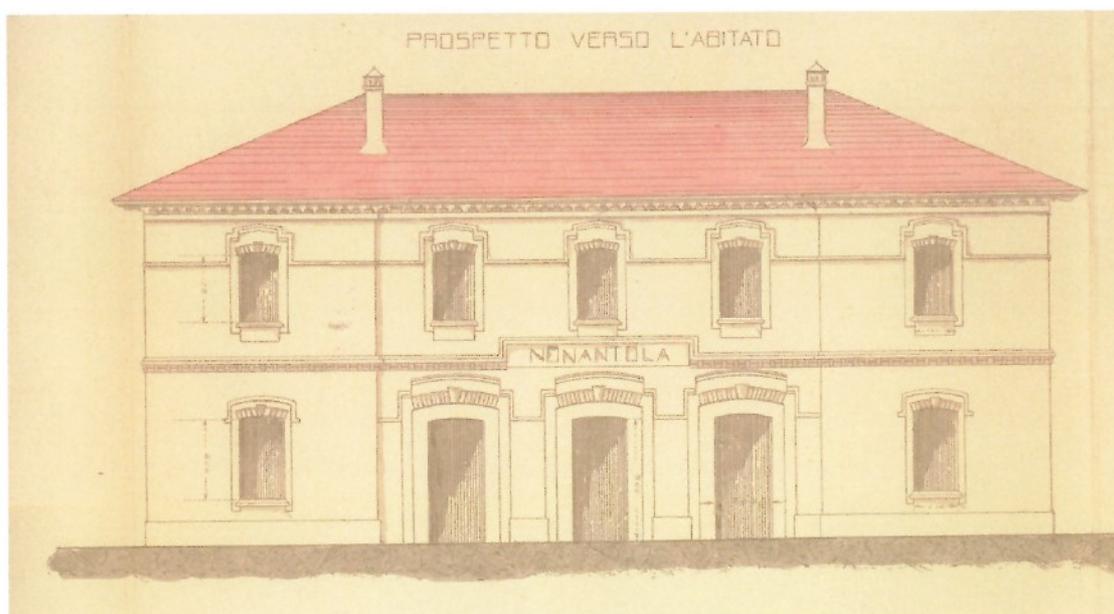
“Prospetto della Stazione di Nonantola della ferrovia Modena” –Decima, 1913.
